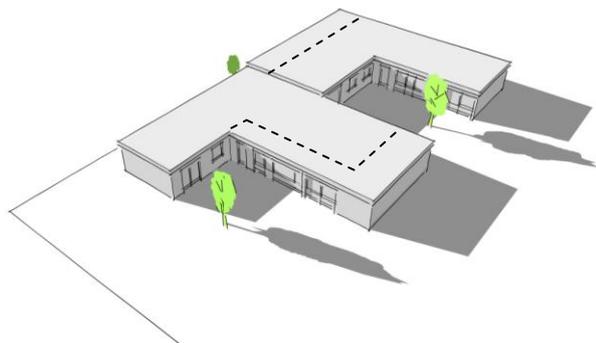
Beispiel für eingeschossige Erweiterungsmöglichkeit Haustyp 6, eigene Darstellung
